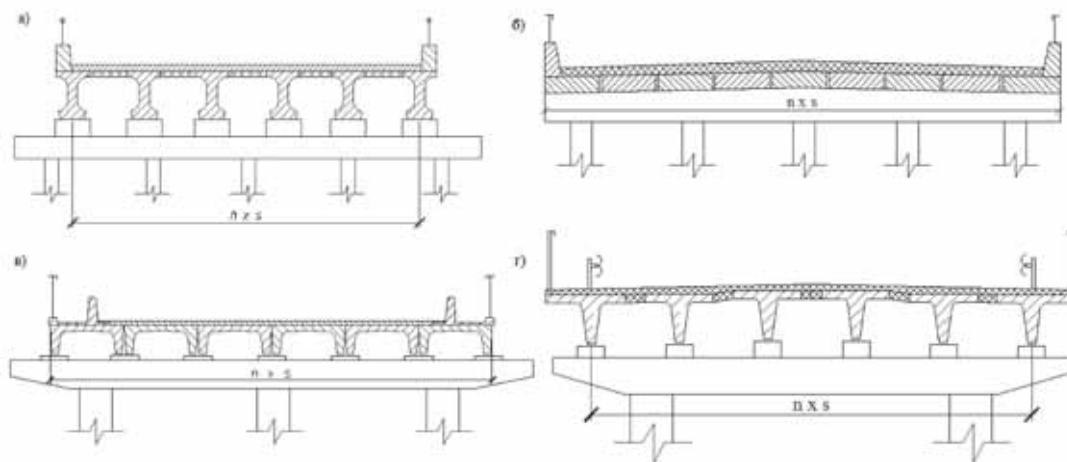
Типы железобетонных пролетных строений на дорогах регионального и федерального значения Республики Саха (Якутия): а – преднапряженное железобетонное пролетное строение с двутавровым сечением; б – плитное пролетное строение; в – железобетонные сводчатые плиты; г – железобетонные пролетные строения с тавровым сечением без диафрагм
